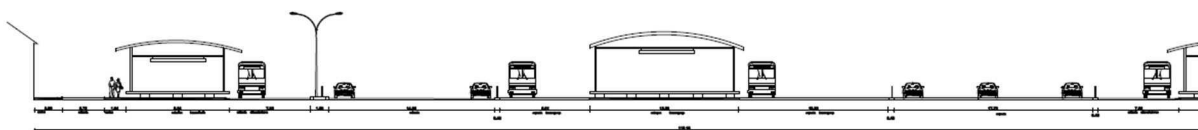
Perfil vial sobre troncales Transmilenio. Autoría propia
